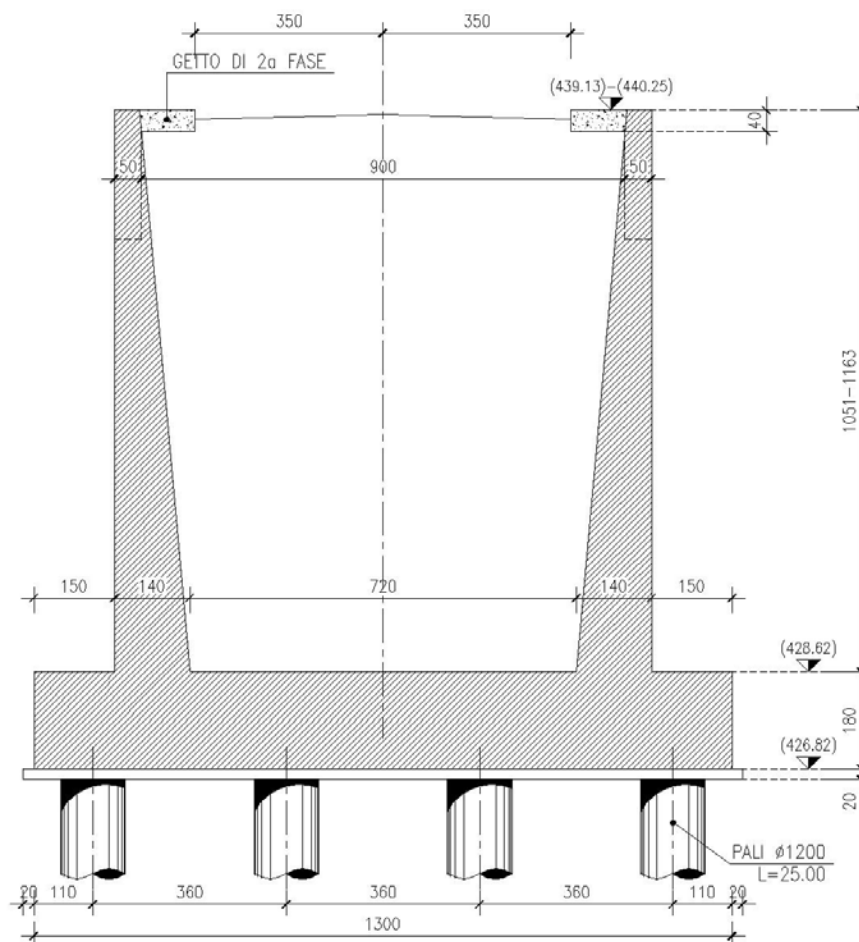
Sezione trasversale della spalla 1.
